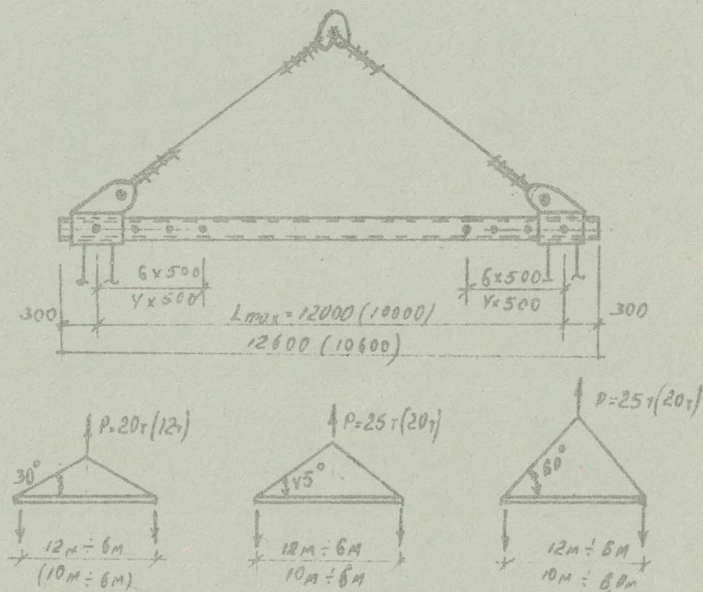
Универсальная траверса для подъема ферм УкрПТИ и монтажных строп
